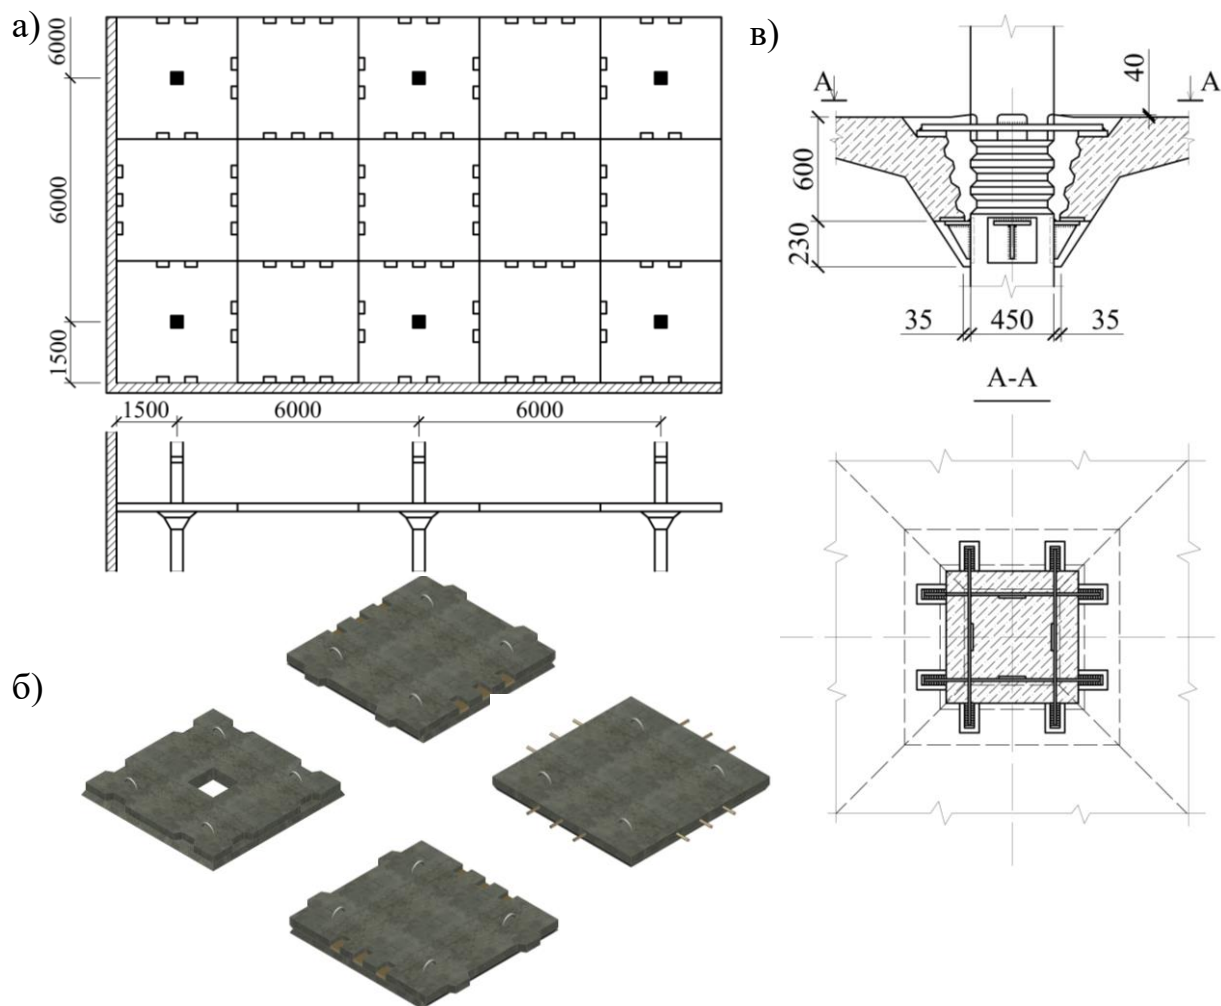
Каркас безбалкового перекриття (а), елементи перекриття (б) та вузол сполучення капітелі з колоною (в):
